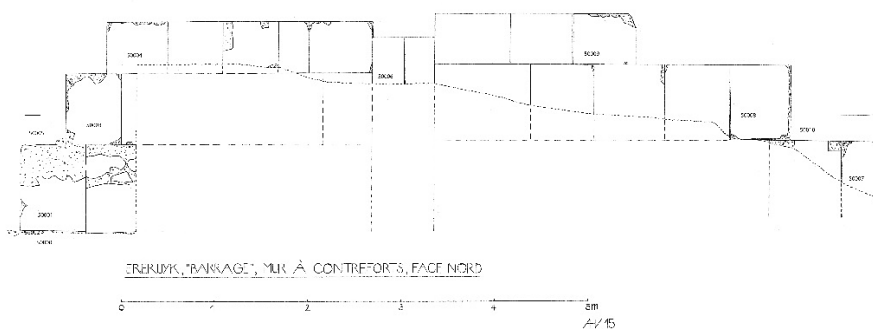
Ereruyk. Murs transversaux au vallon au sud du site. Relevé pierre-à-pierre de la face
